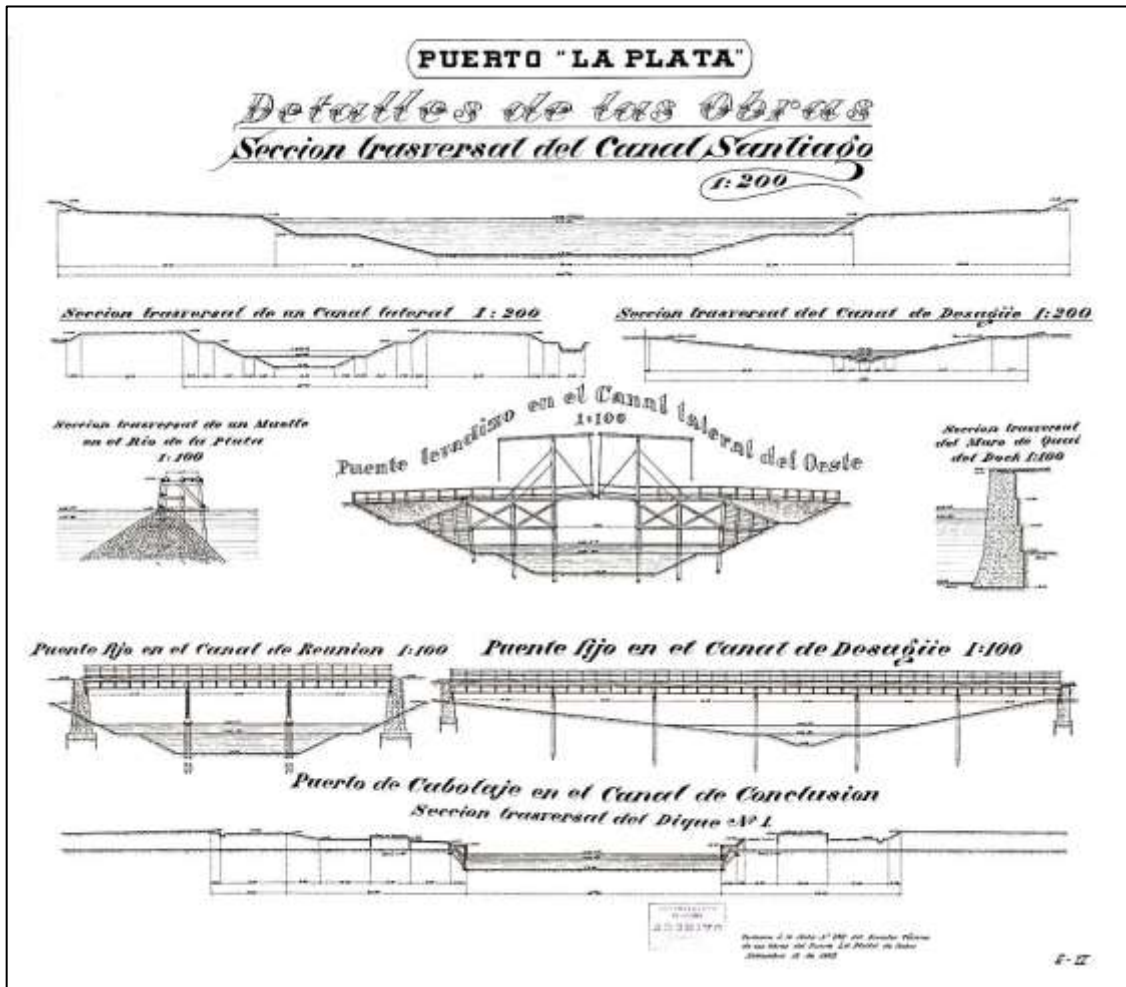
Plano de obra, 1885 y Puentes giratorios, levadizos, fijos...
